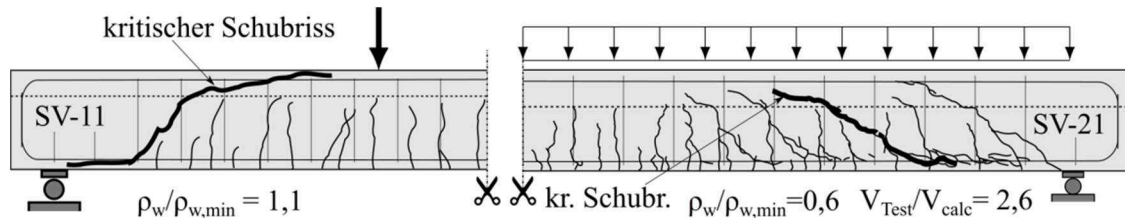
Rissbild und Traglaststeigerung bei Bauteile mit Querkraftbewehrung [1]
